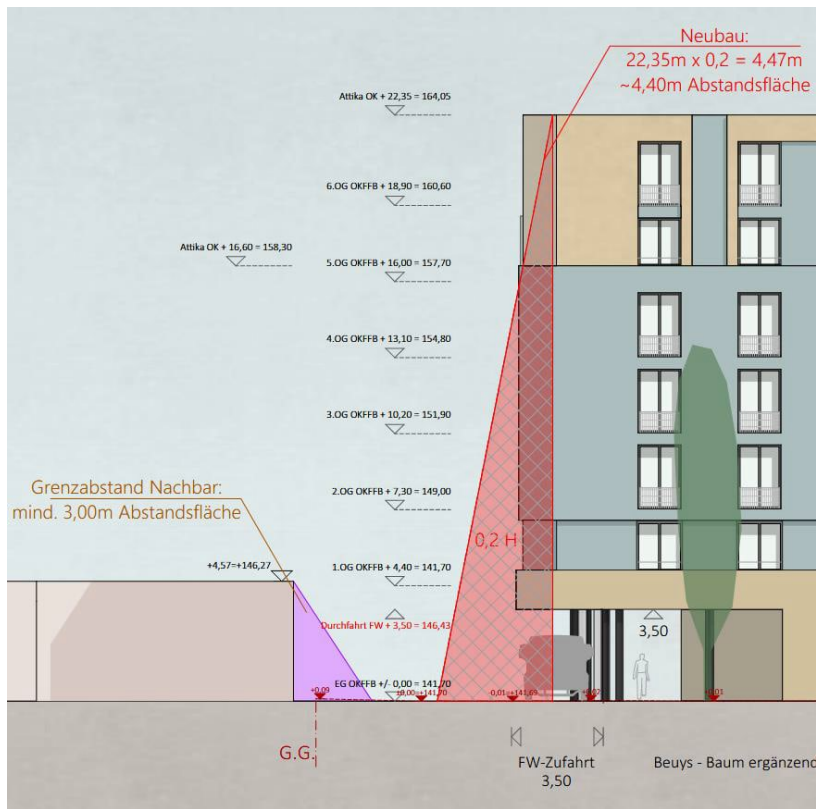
Darstellung der Abstandsflächen an der nördlichen Fassade des Vorhabens
